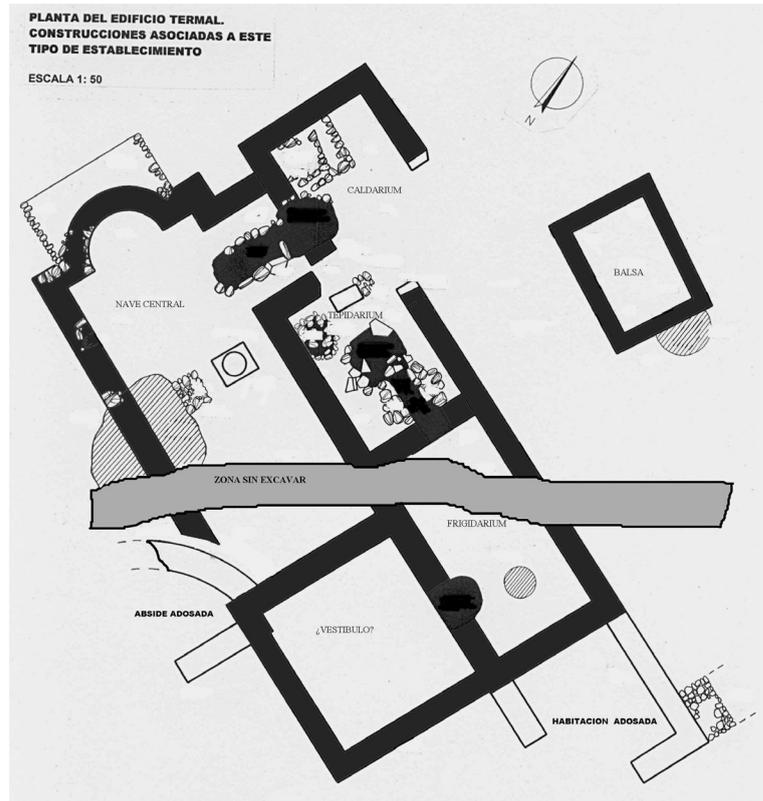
Planta de los baños de la villa del Palau (Borriana) (Melchor y Benedito, 2016)
